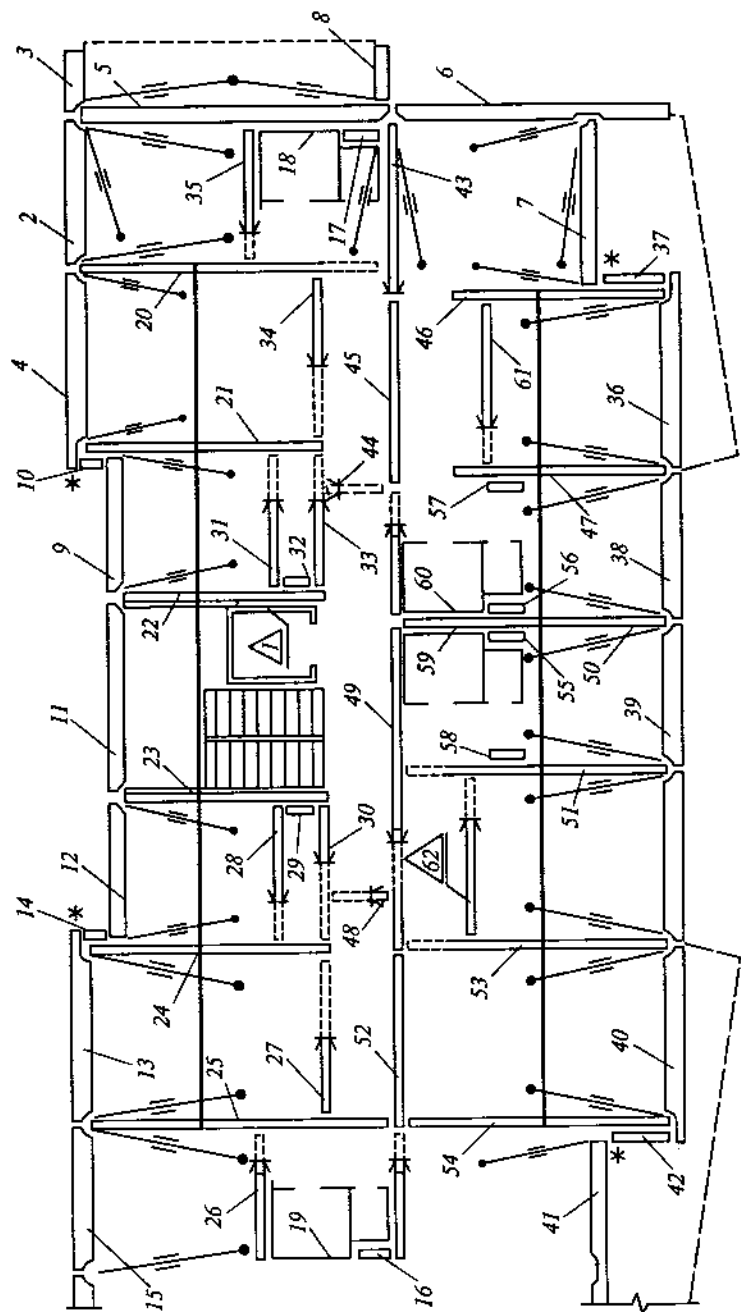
Монтаж здания с поперечными несущими стенами от базовой панели
